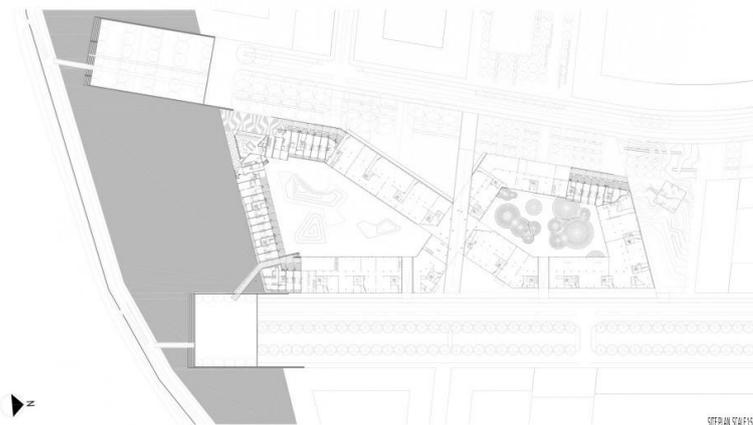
Planta arquitectónica de conjunto 8 House. Fuente:
